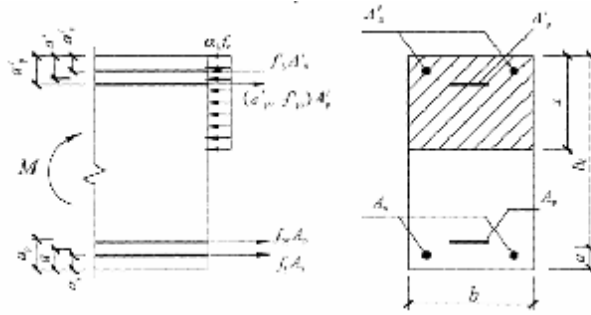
矩形截面受弯构件正截面受弯承载力计算
